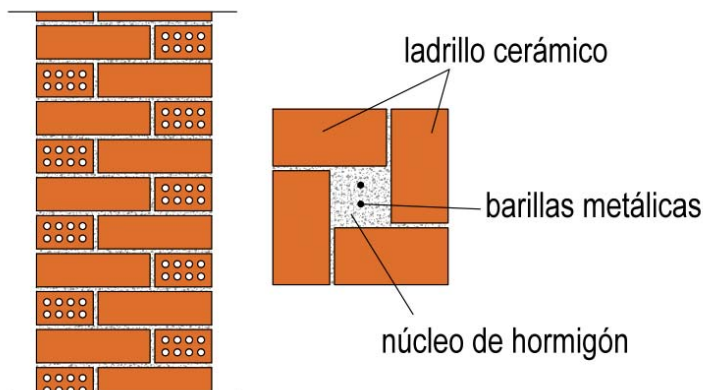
Pilar existente en la vivienda. Fuente propia.
